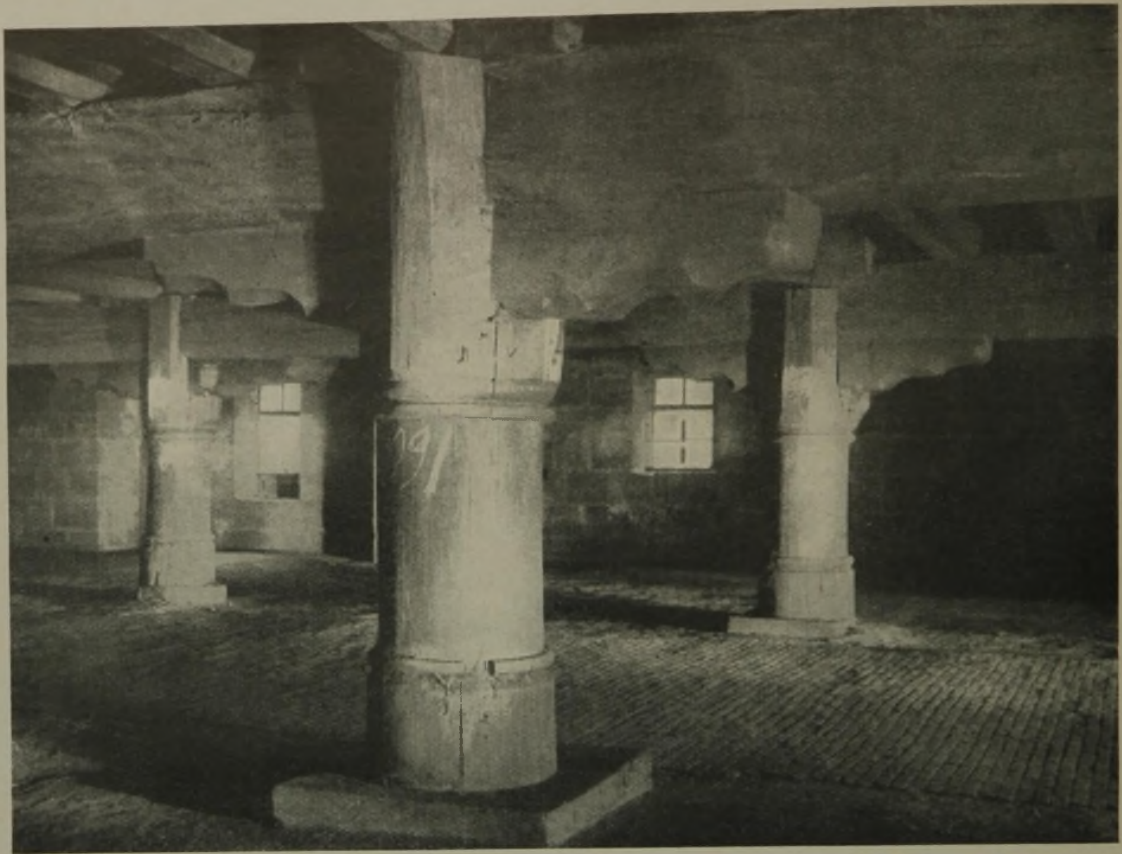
u. 3. Erstes Obergeschoß und Erdgeschoß der „Mauthalle“ in Nürnberg, erbaut 1498—1502.
